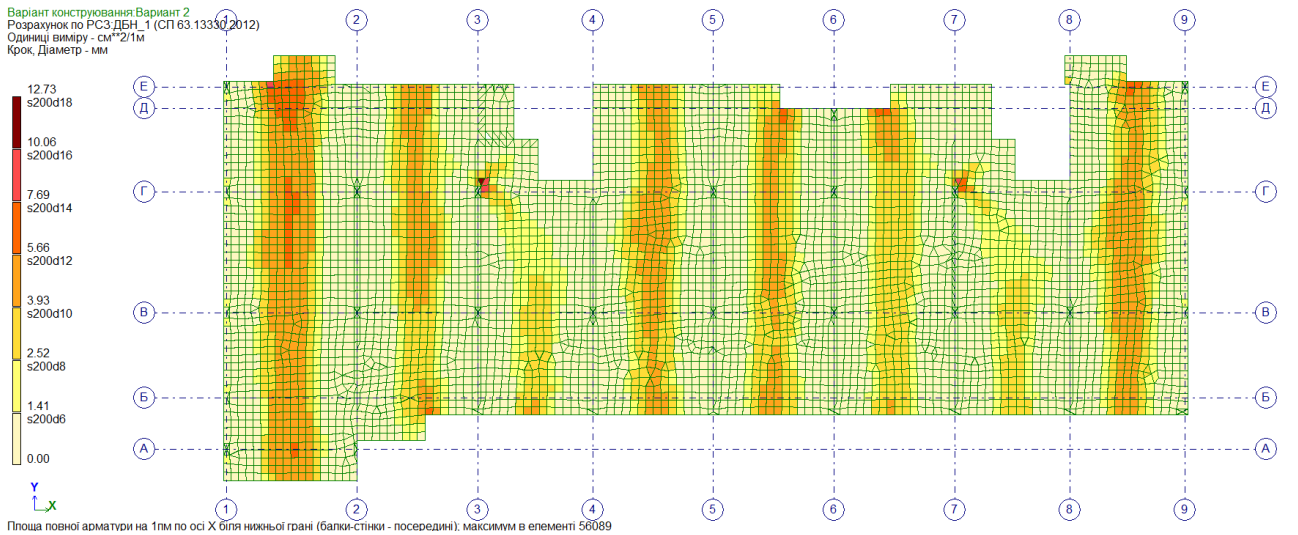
Ізополя розрахункового армування плити перекриття типового поверху. Нижня арматура вздовж осі X
